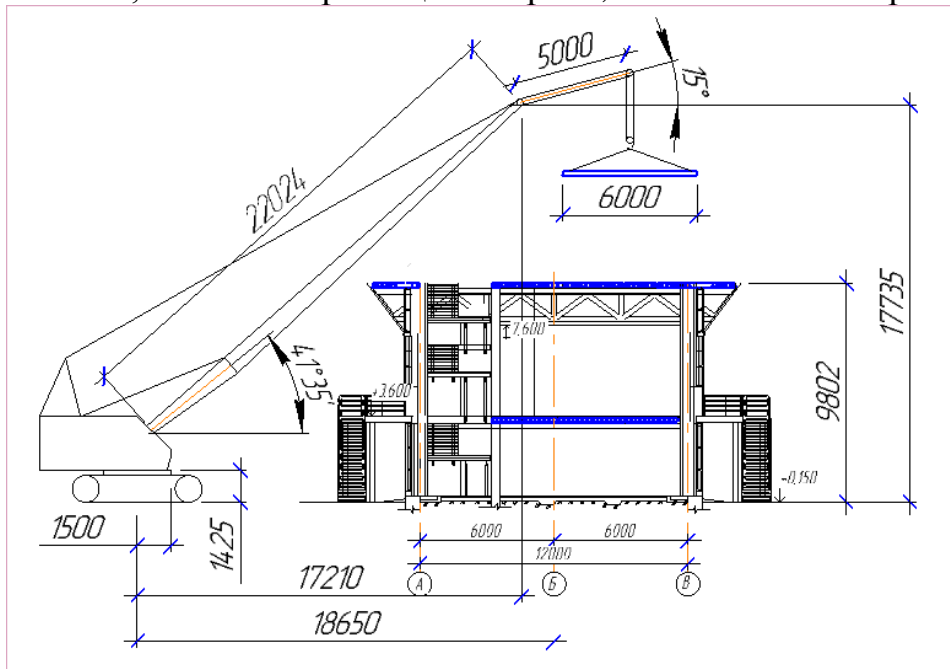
Поперечная привязка оси крана к зданию
